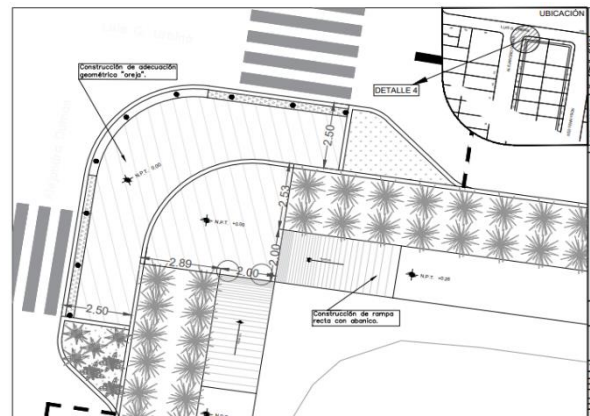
Detalle de plano ubicando cambio de diseño de rampas con extensión de banqueta en la Alcaldía Miguel Hidalgo. Elaborado por Muñoz Alvarez, Jessica.
